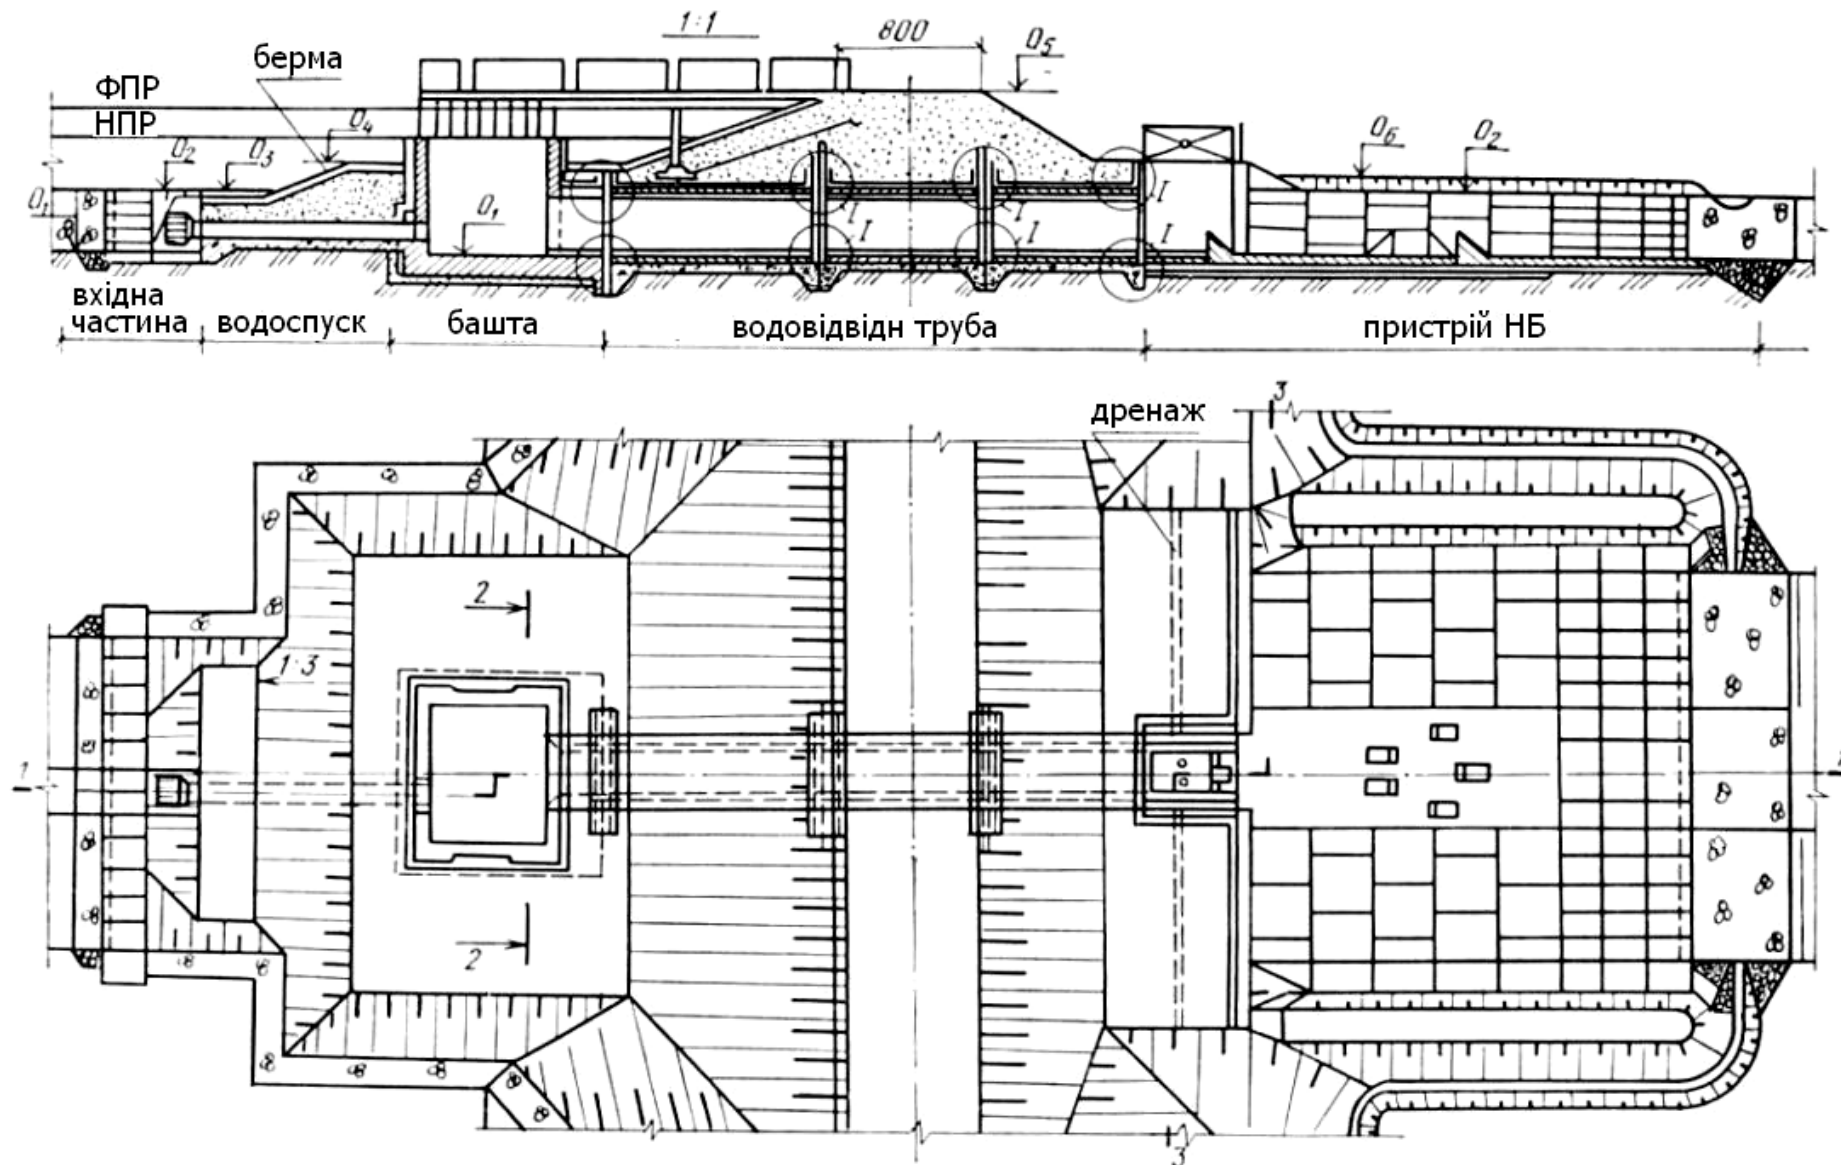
Схема гідровузла з баштовим водоскидом
